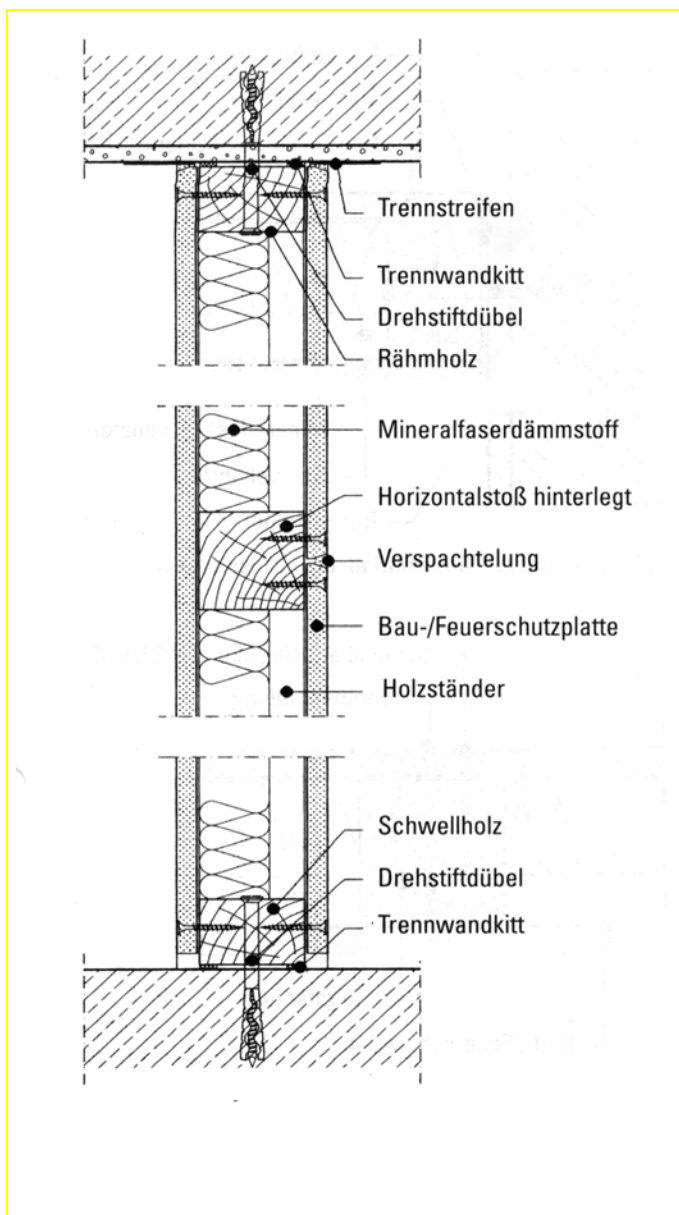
Einfach beplankte Holzständerwand (Galiläa, 1998)
